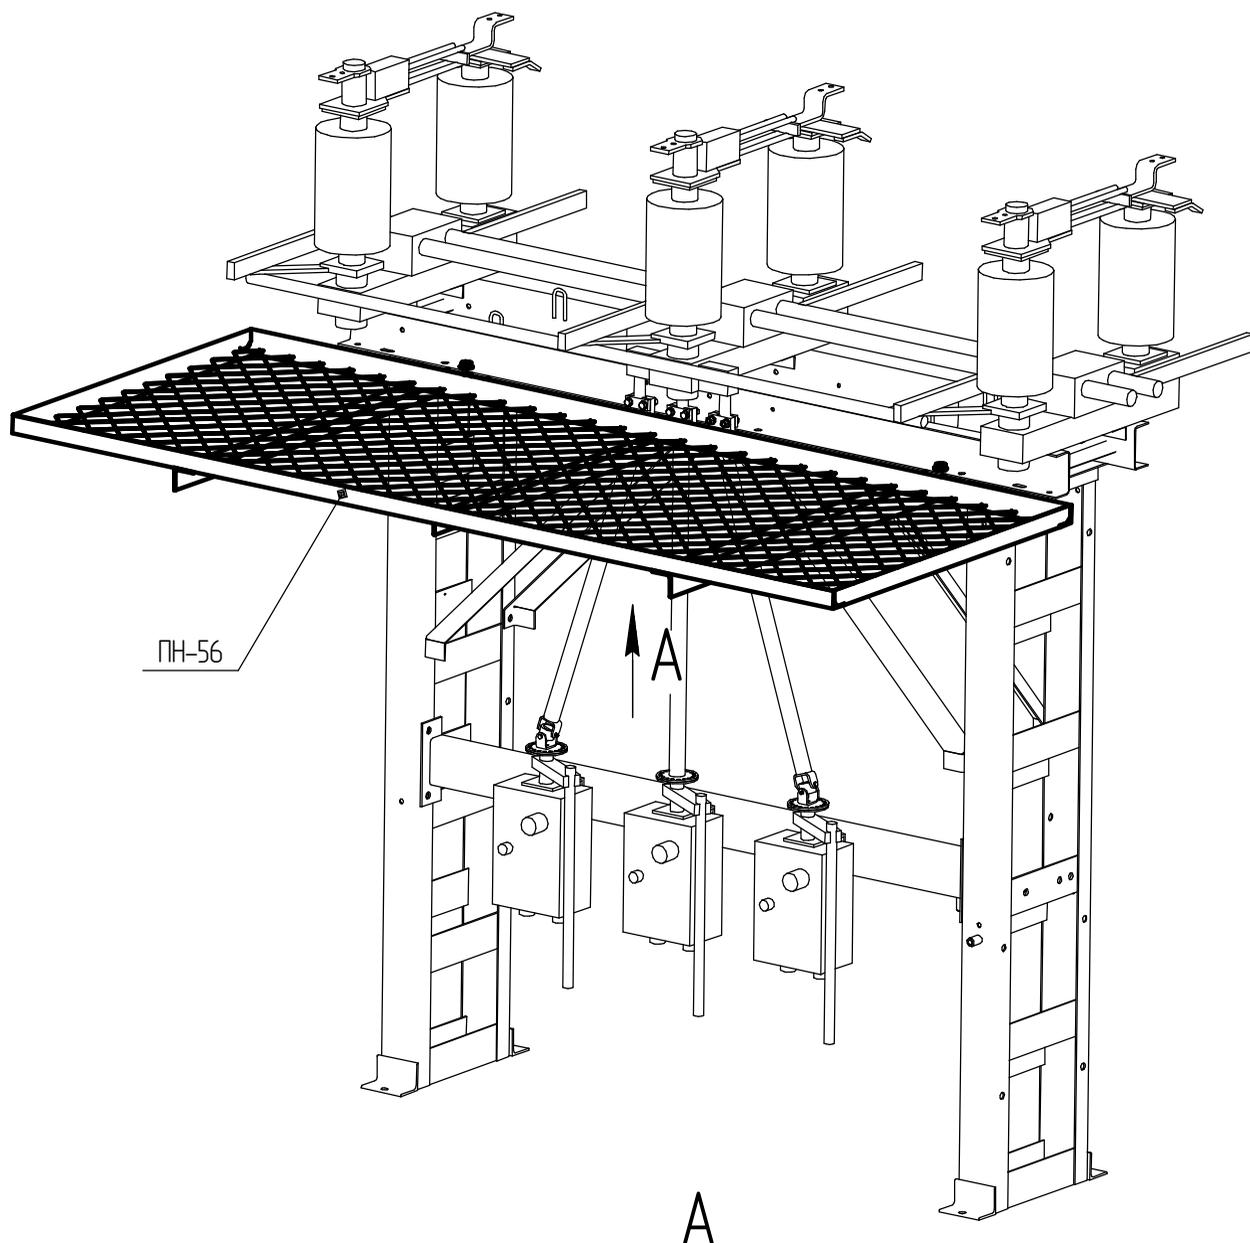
Установка на блок разъединителя 35 кВ
